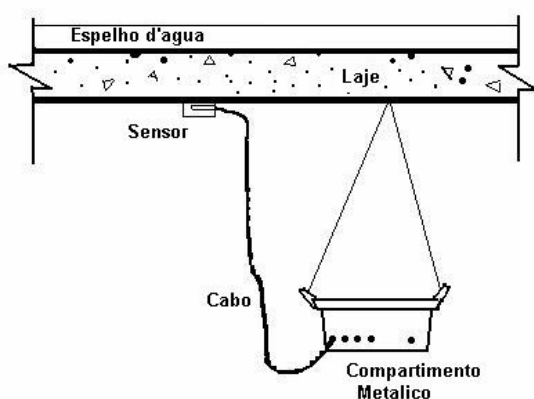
Croqui de Instalação do Equipamento na laje EA.
